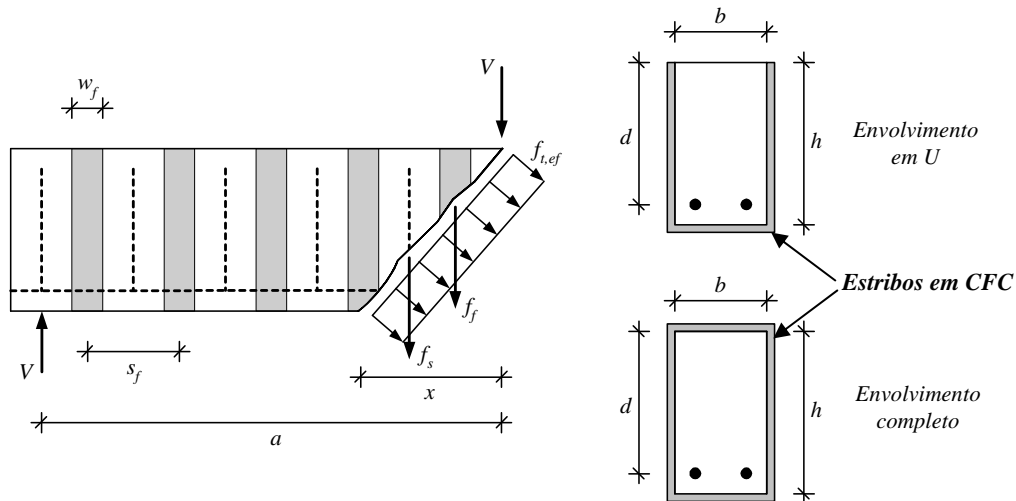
Esquema do modelo da fissura deslizante para vigas de concreto armado reforçadas com estribos em CFC; adaptada de Sánchez *et al.* (2006).
